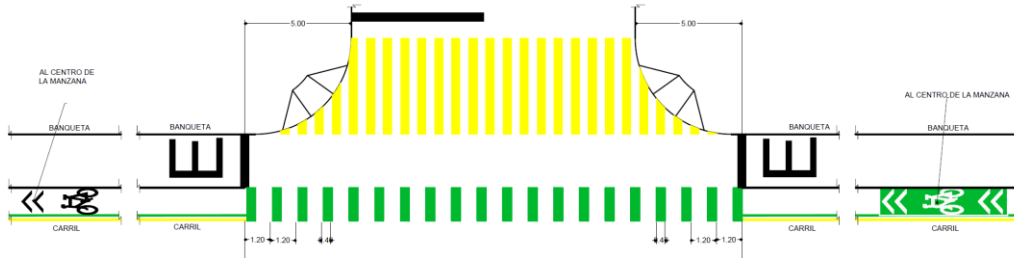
Detalle de señalamiento horizontal Tipo 3, manzanas menores a 100m.
